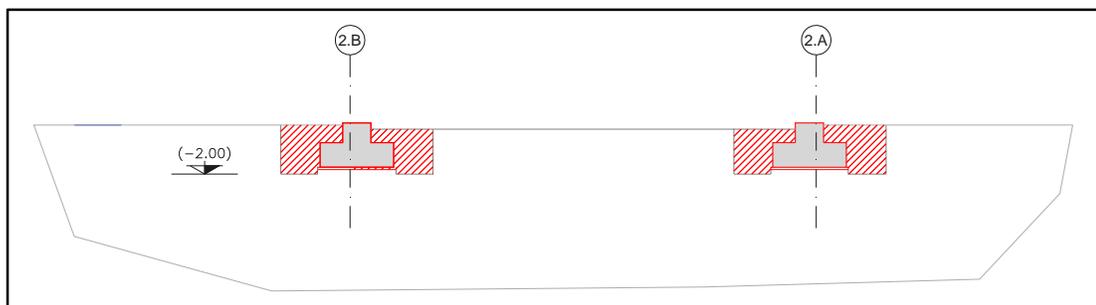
scavo trincee di accesso a sezioni periferiche (travi rovesce) fondazione
